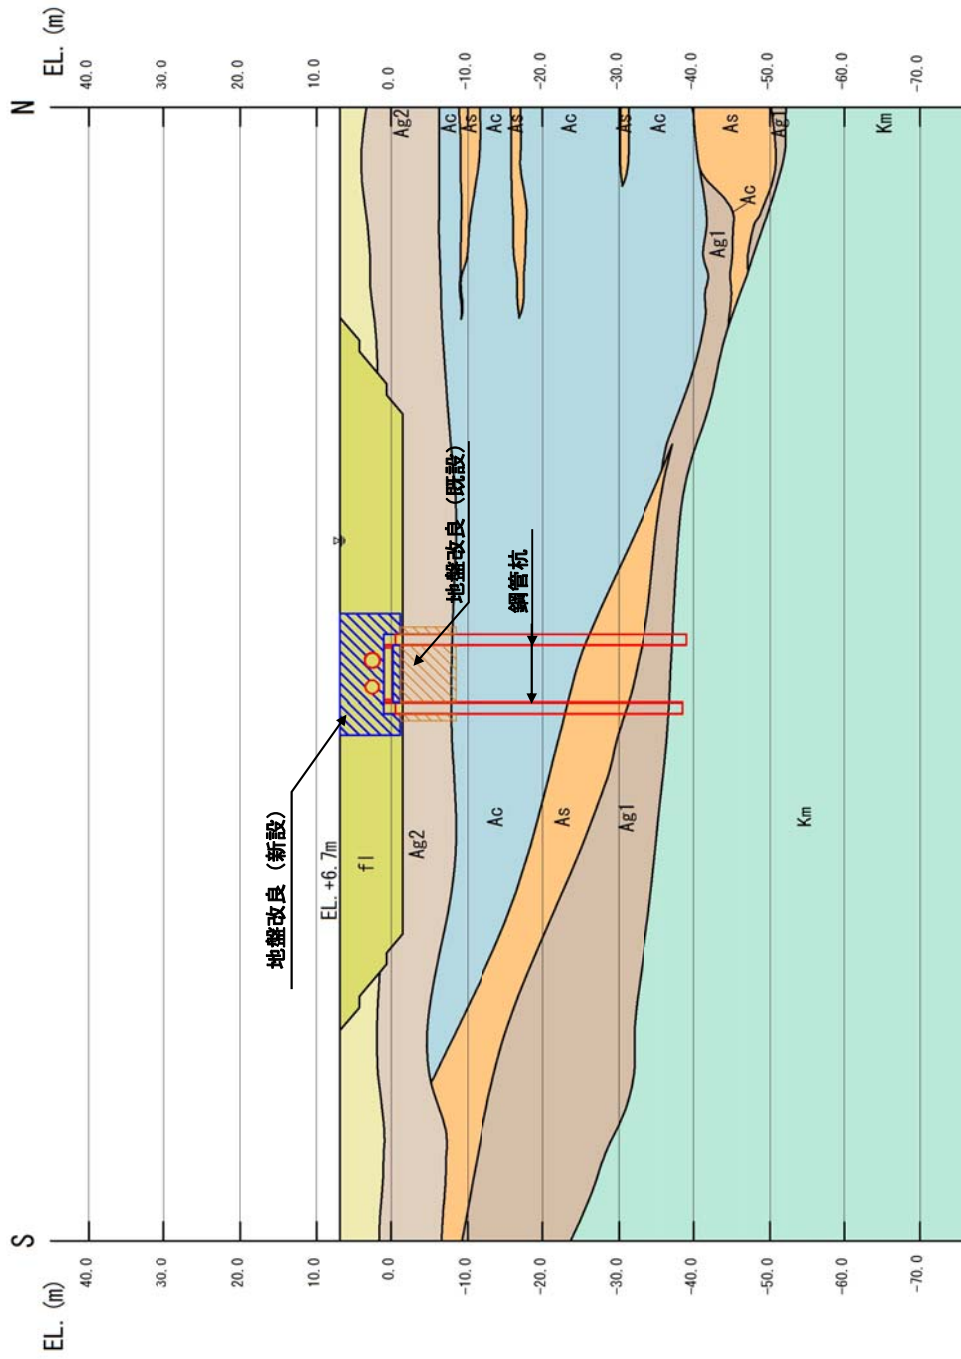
(2) 屋外二重管基礎の評価対象断面図 (B-B 断面)
